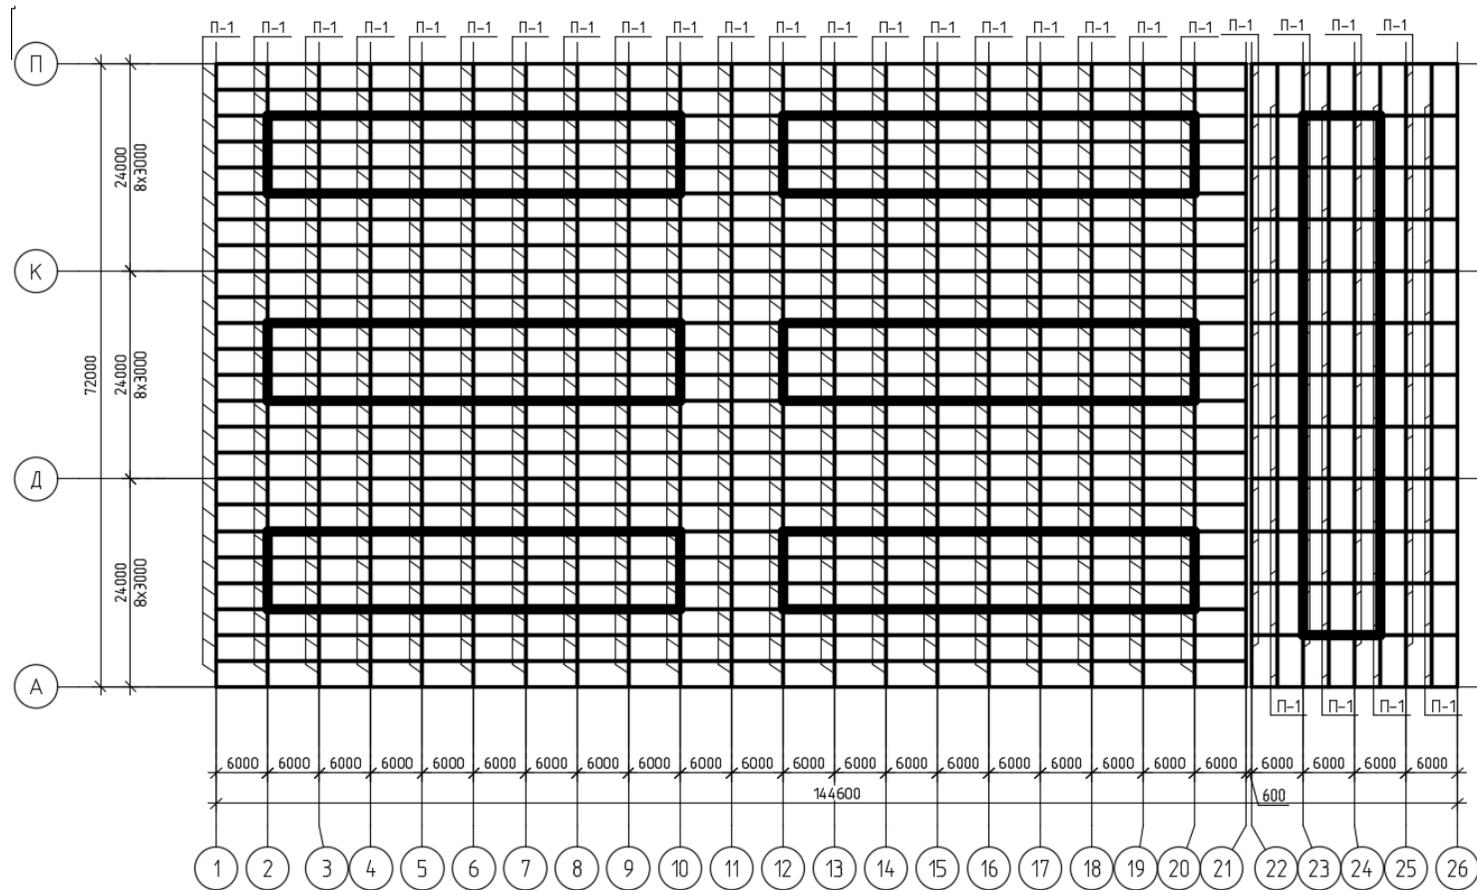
Совмещенная схема расположения плит покрытия на стропильных конструкциях и конструкциях светоаэрационных фонарей
